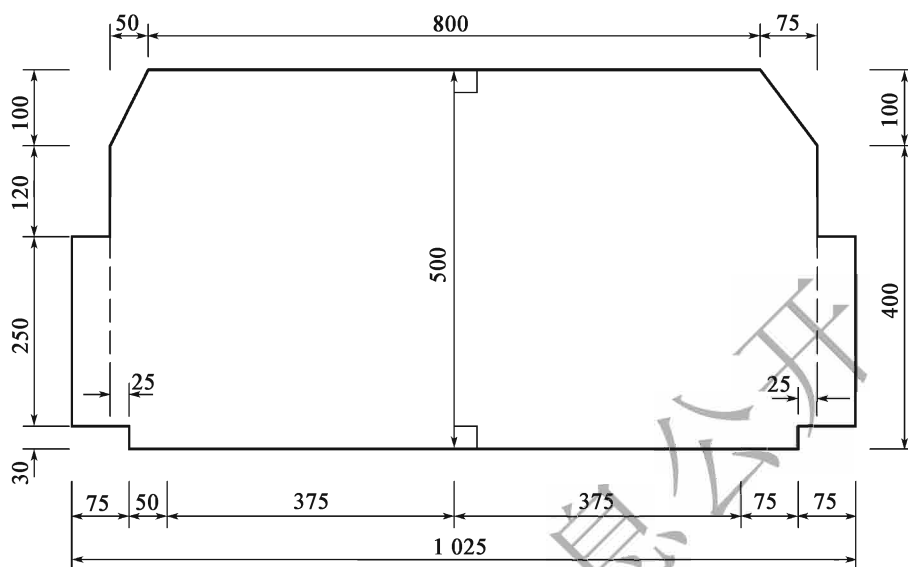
Dégagement de construction du tunnel autoroutier et du tunnel routier de première classe à deux voies(80km/h) (unité:cm)
